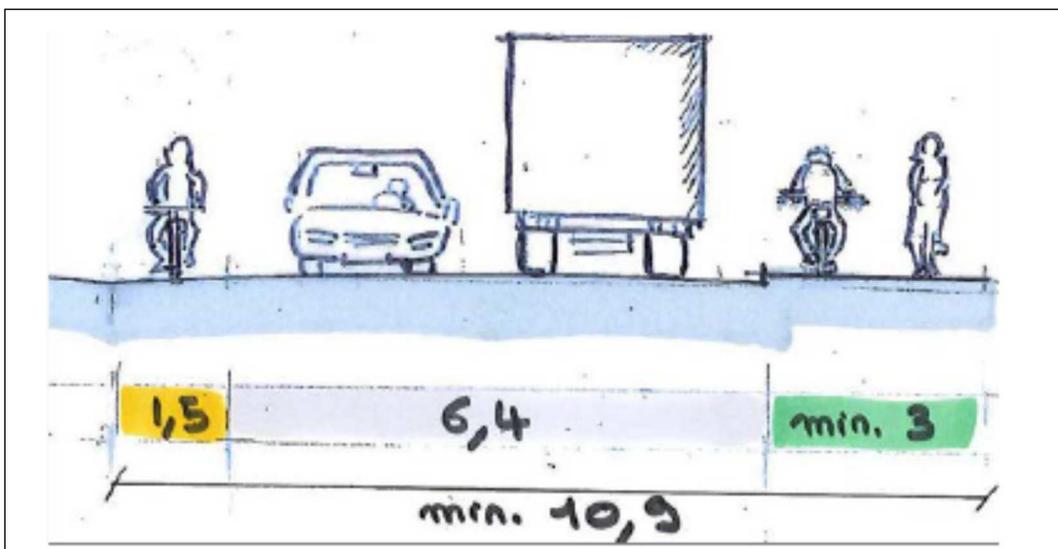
Gabarit minimum en section (en m tres) sur la RC 1 hors travers e de localit  (vitesse < 60 km/h)
